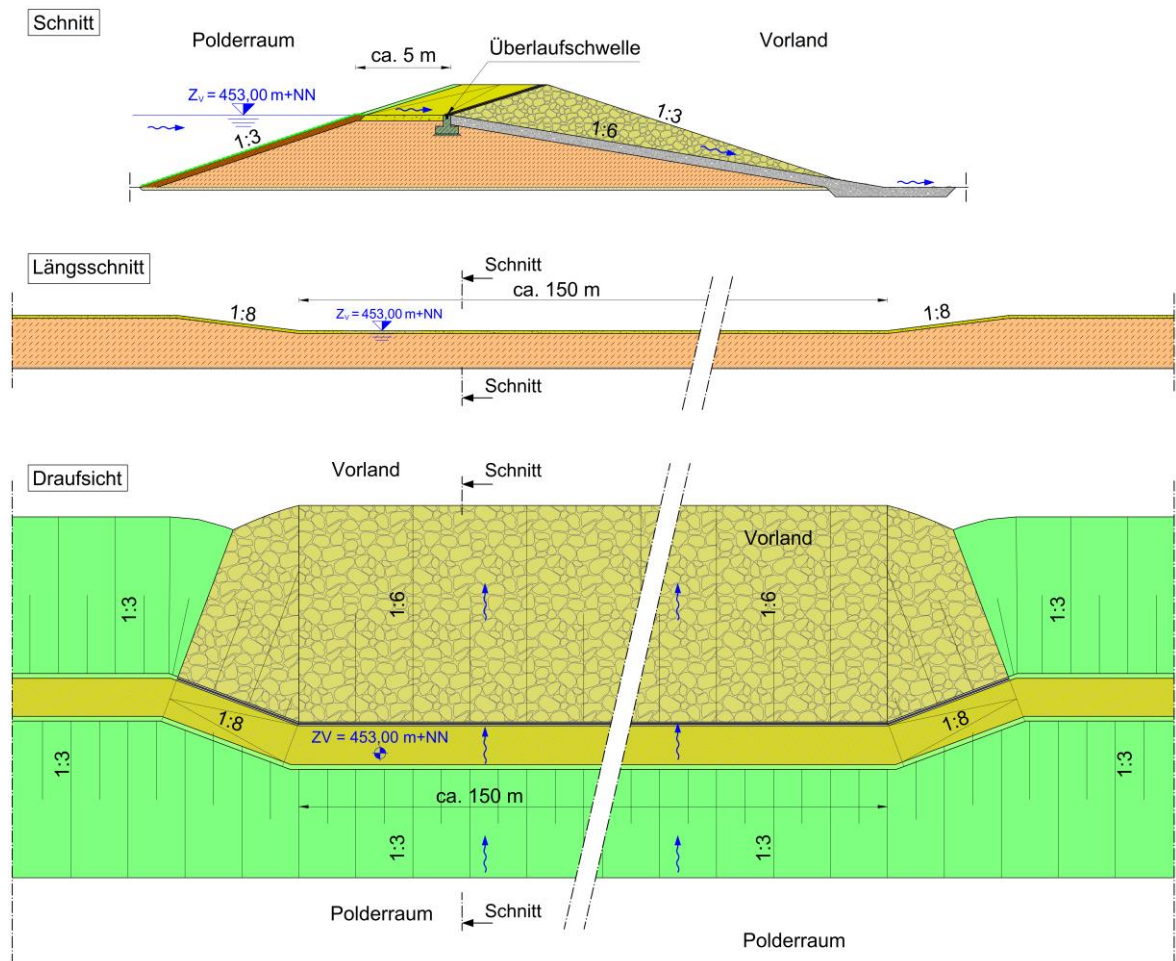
Ansicht, Längsschnitt und Schnitt A-A durch Hochwasserentlastungsanlage
